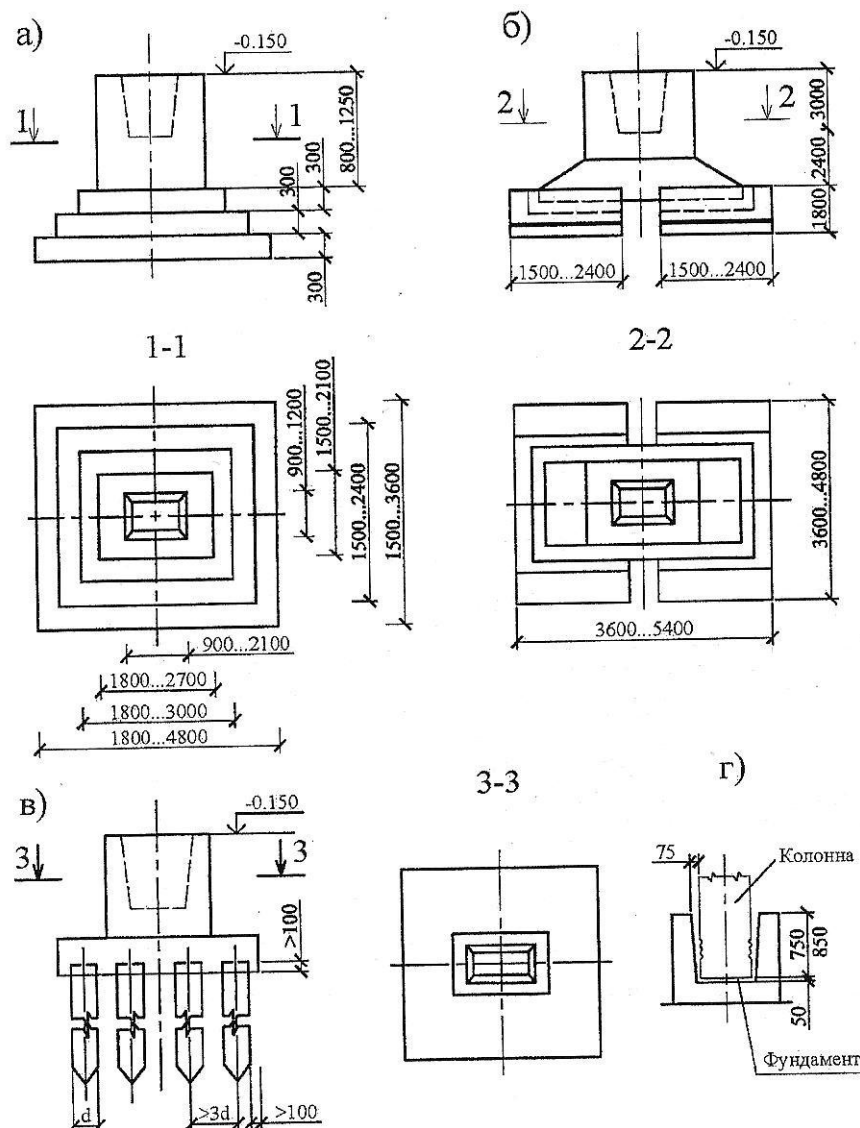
Фундаменты под железобетонные колонны: а- монолитный, б- сборный, в – свайный, г- заделка колонны в фундаменте
